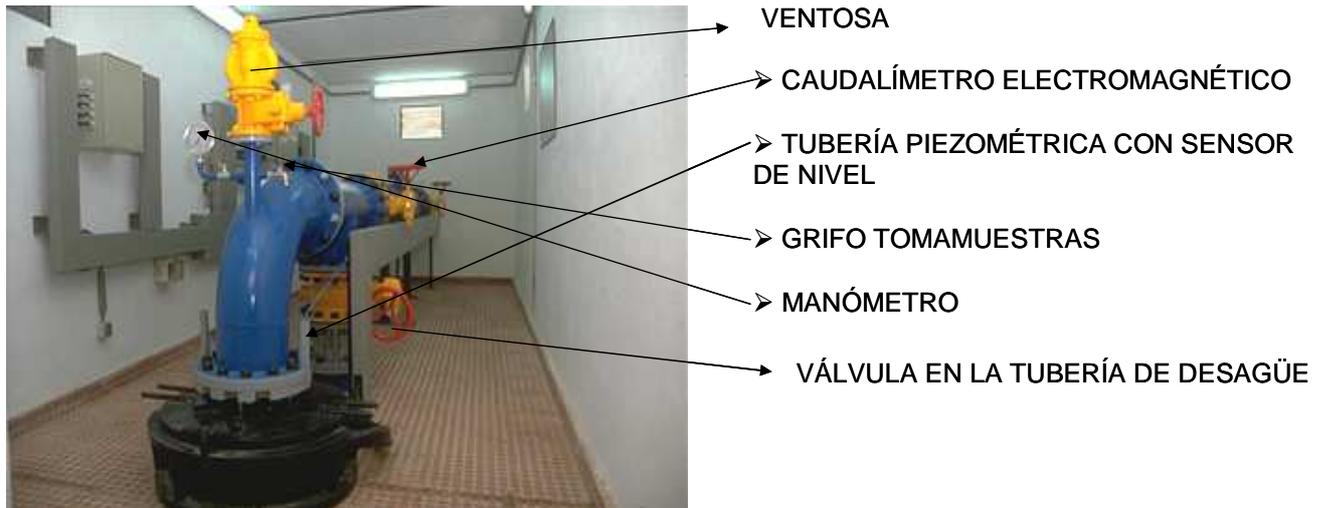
Situación de tubería piezométrica, válvulas y caudalímetro en la arqueta del pozo.
